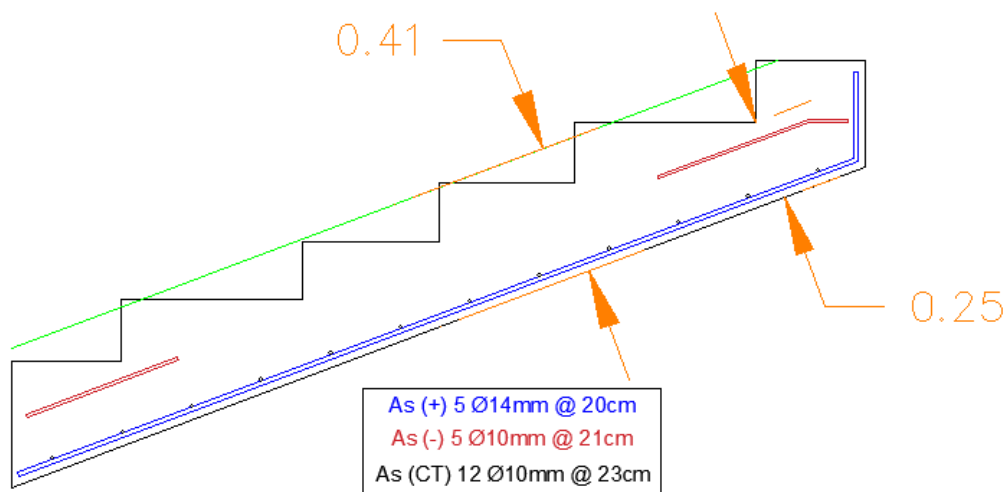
Aceros en Tramo Transversal Central de las Escaleras. Fuente: Nicolás Pozo
